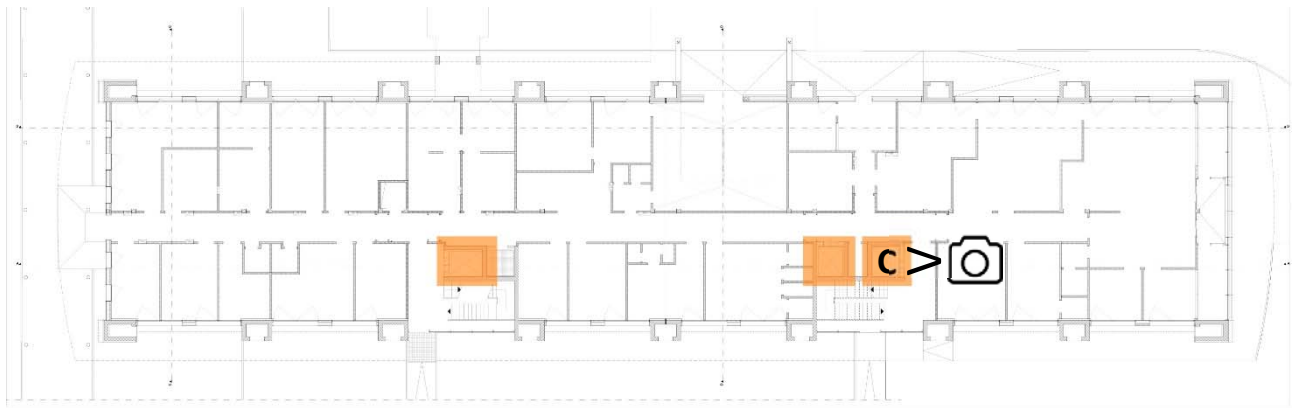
Vano corsa elevatore B: piano primo vista verso il basso
